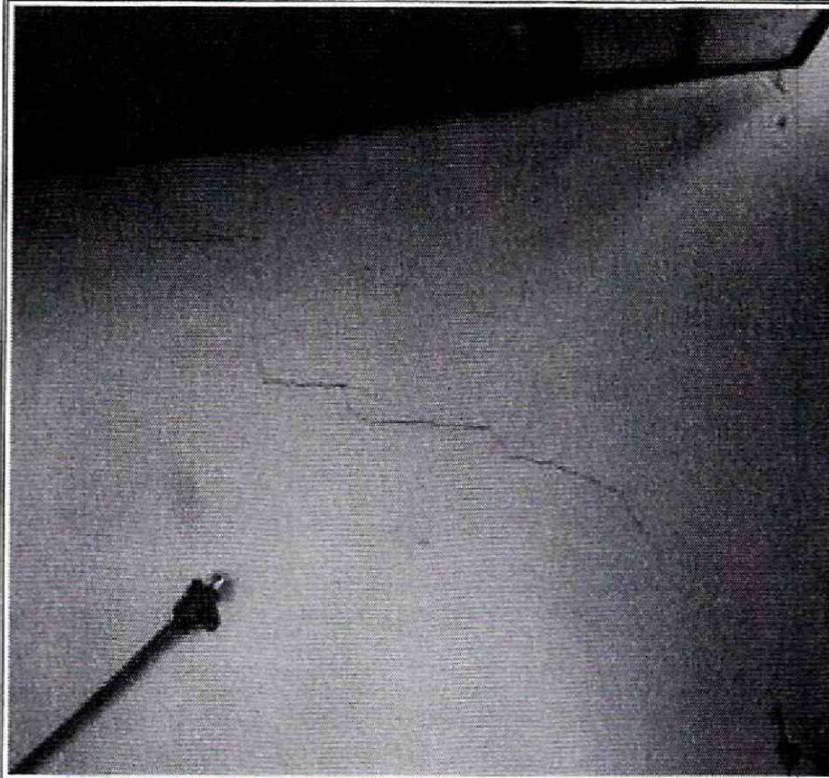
Grieta tendencia escalonada muro de cerramiento perimetral costado norte del predio de la Transversal 8 B Este No. 89 – 46 Sur
